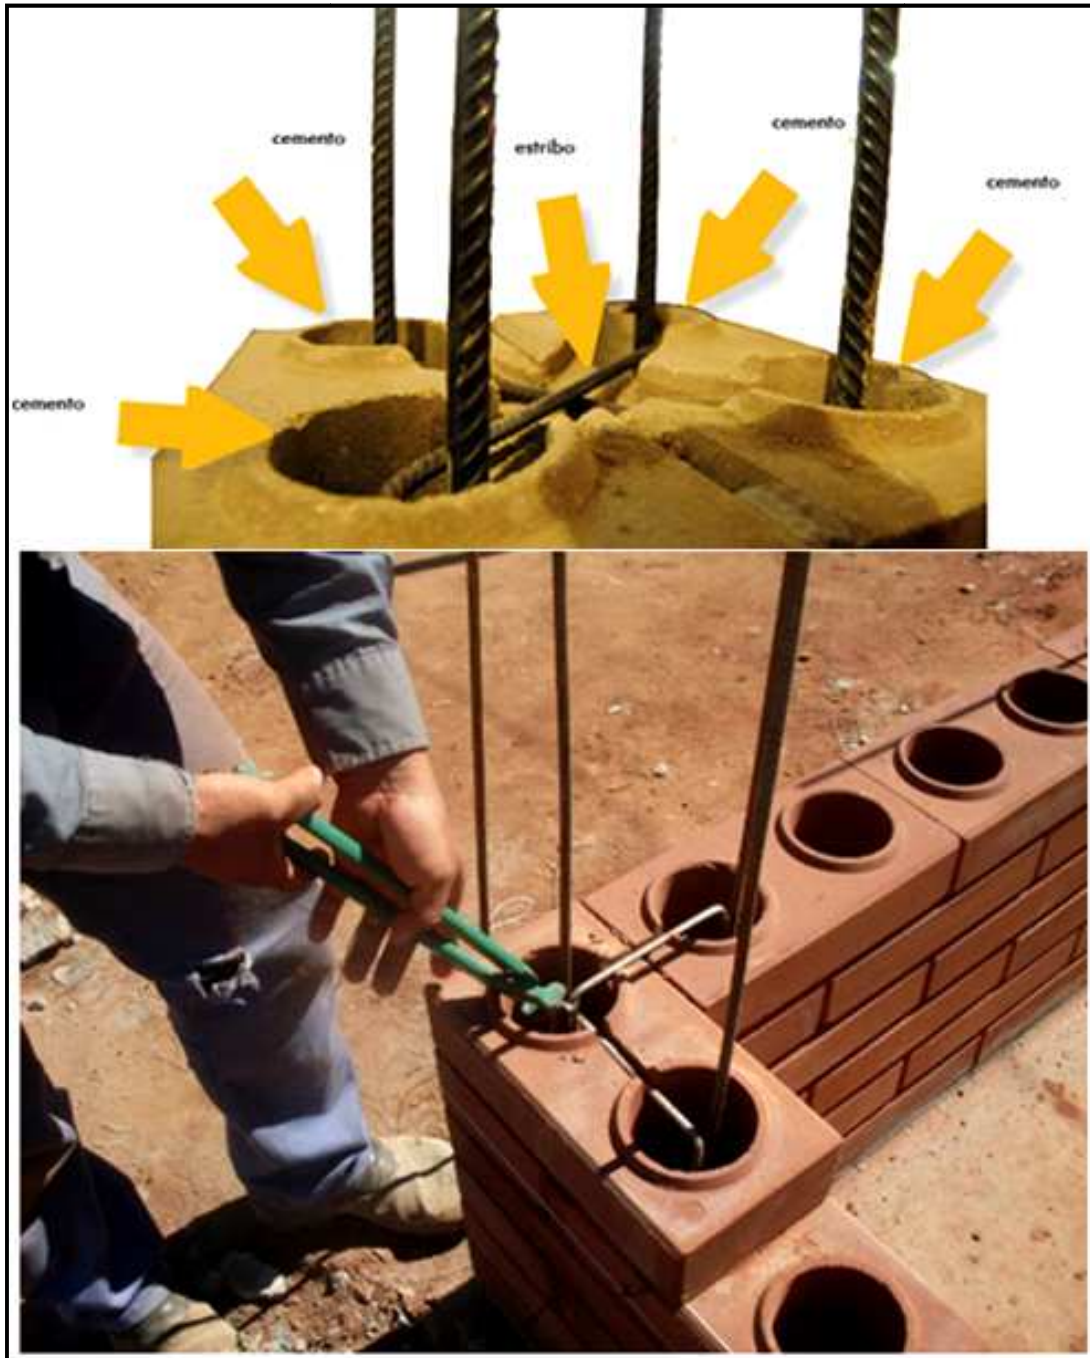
4: Armado de columnas con el sistema de ladrillos de suelo-cemento
